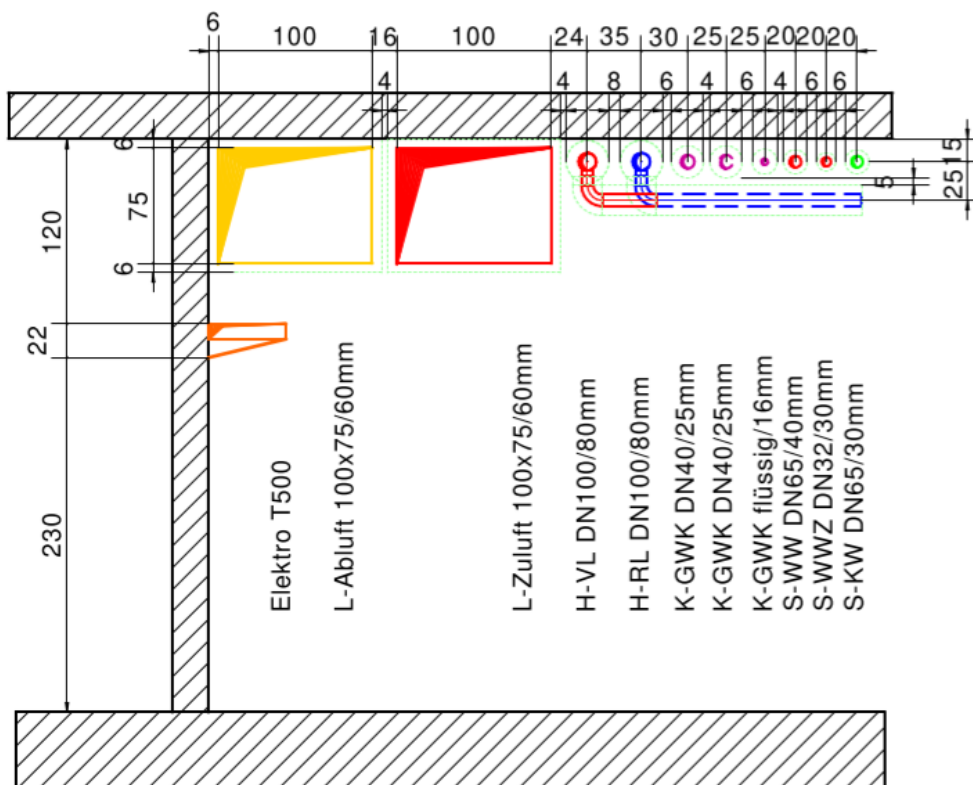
Funktionsschnitt Hauptkorridor Erdgeschoss
